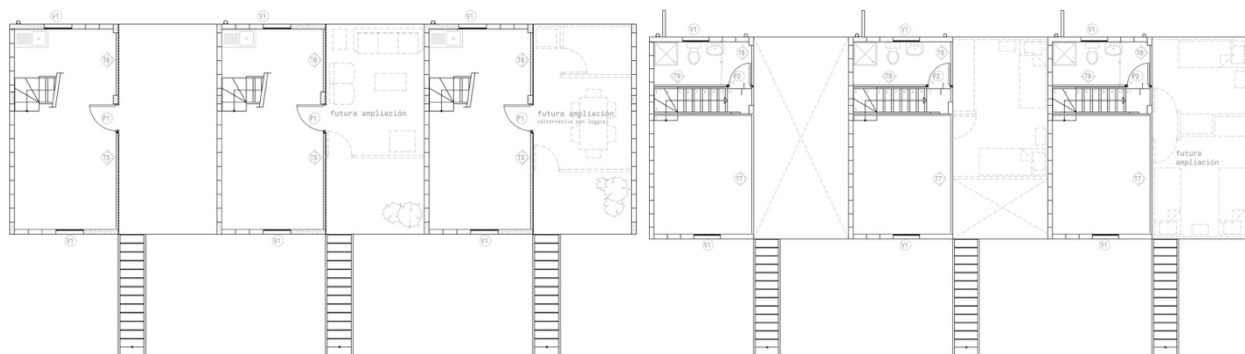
Planos originales del proyecto Quinta Monroy del Arq. Alejandro Aravena (Aravena, 2007)
